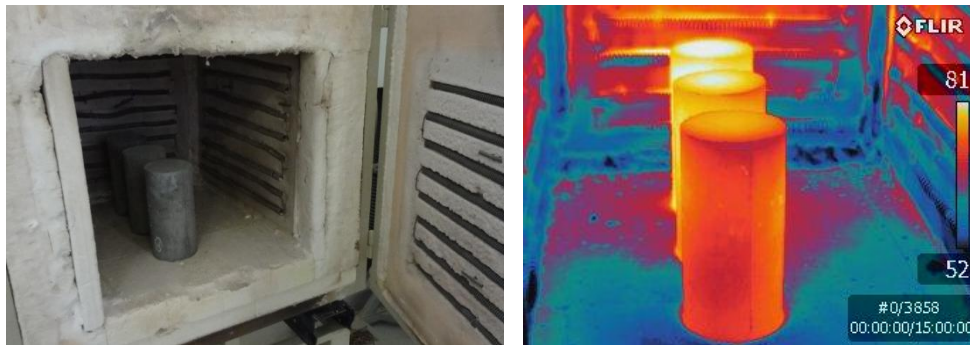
Aquecimento dos corpos de prova de concreto
